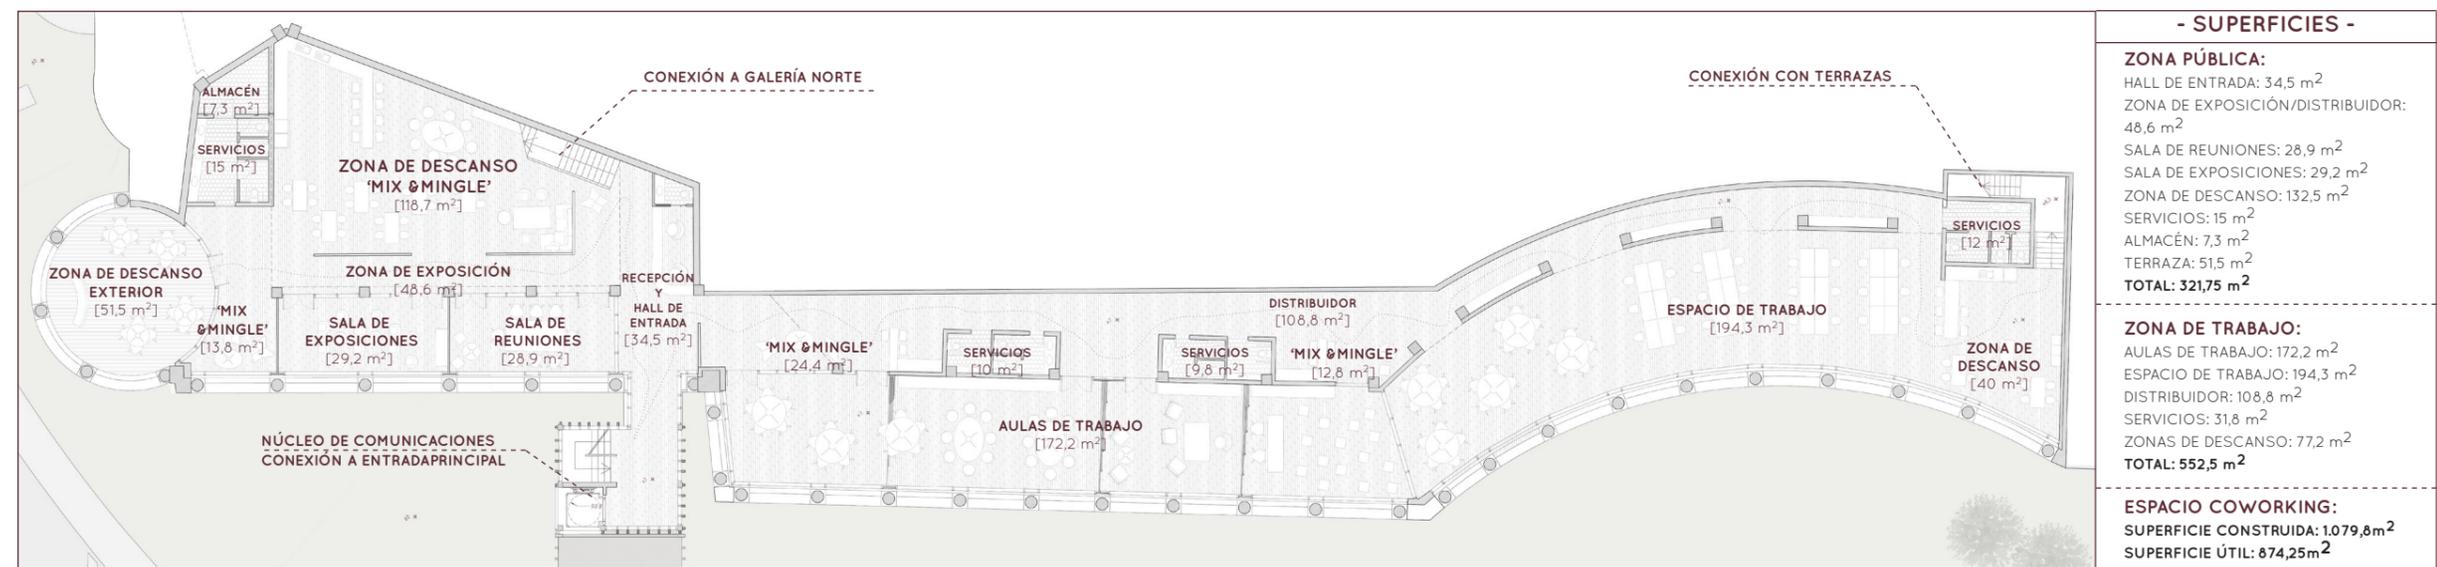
Planta y programa del espacio coworking en la galería suroeste.
